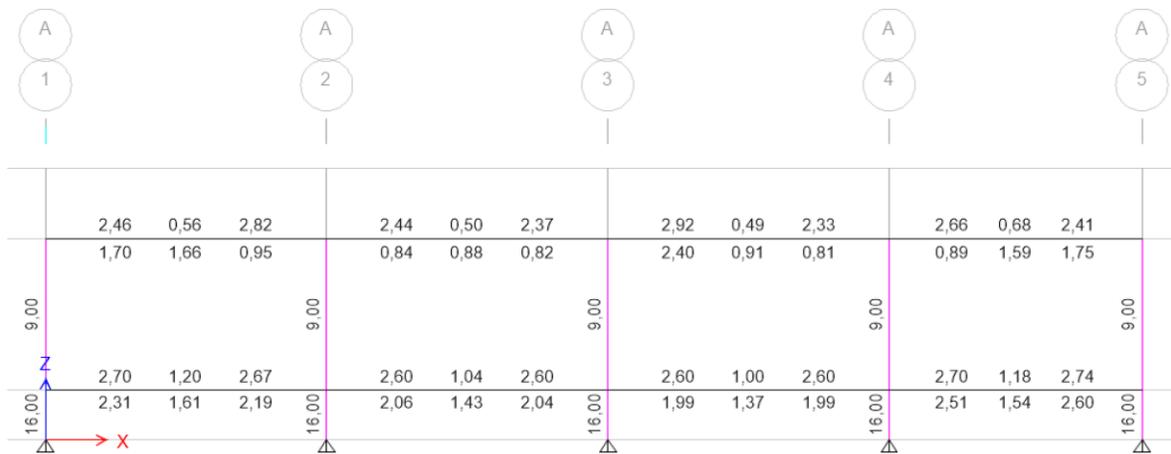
Acero requerido por columnas, pedestales y vigas del eje A en cm<sup>2</sup>
